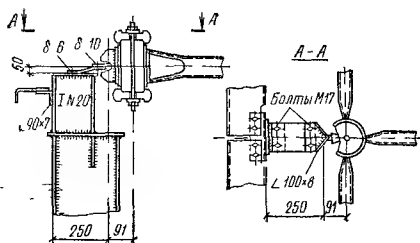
Опираие фахверковой стойки на структурное покрытие из труб
